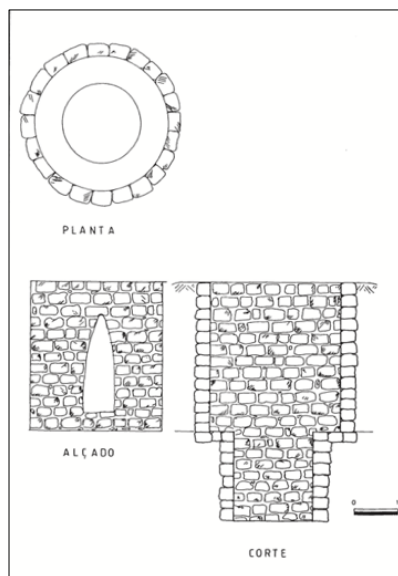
Forno vazio de Trigaches, planta, alçado e corte
